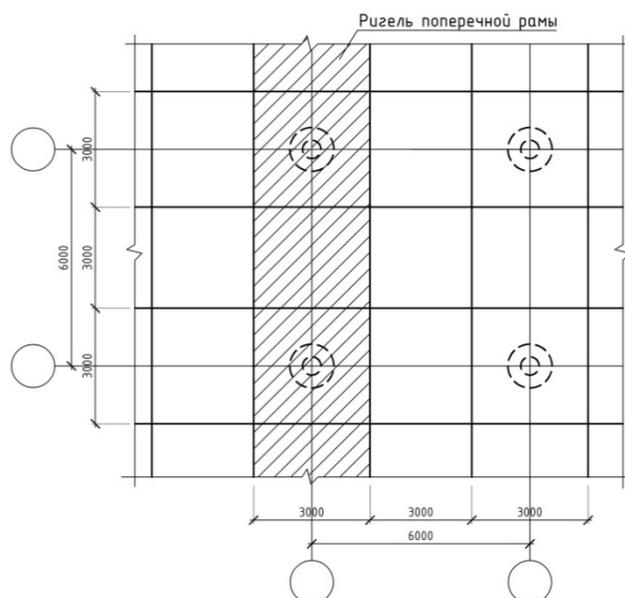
Фрагмент плана безбалочного сборного перекрытия
